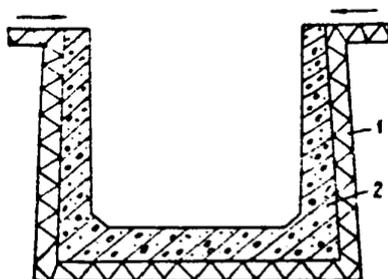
Конструкция водоотводного лотка с теплоизоляцией, укрепленного железобетонным блоком:
